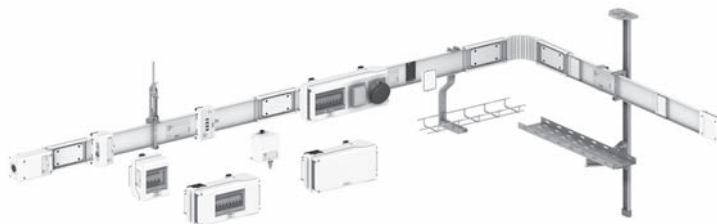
Гибкий шинопровод, не рассчитанный на крепление осветительной арматуры: Canalis KDP (20 A)
